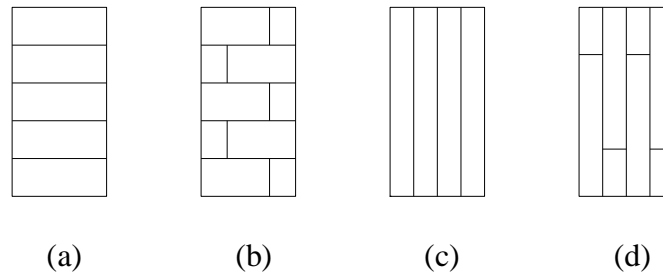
Laminação horizontal sem emendas transversais (a) e com emendas transversais (b), e laminação vertical sem emendas transversais (c) e com emendas transversais (d)
